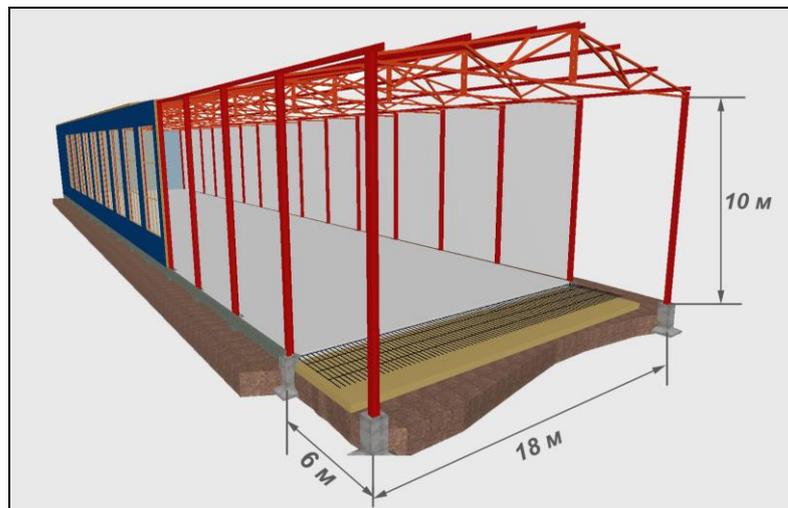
Пример планировки здания пролетом 18 м и шагом колонн 6 м
